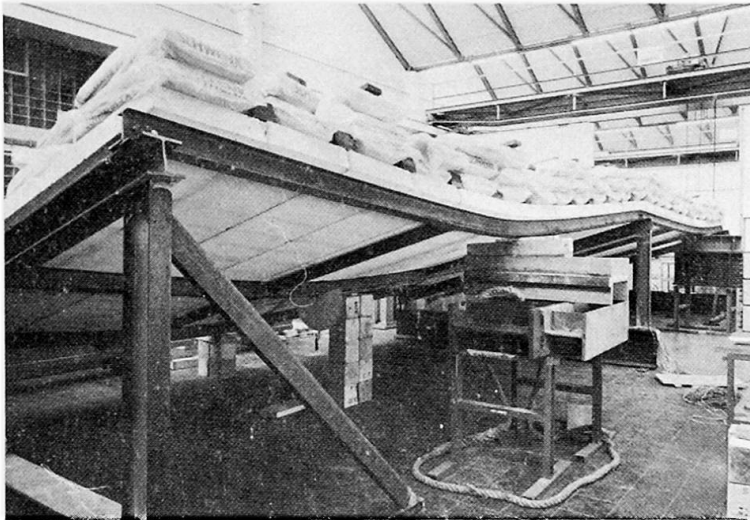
Versuch mit Gasbetonplatten; Pfette IPE 120 über 2 x 6,50 m gestützt; Druckstreben in den Drittelpunkten; Dachneigung 30 % (16,7 °)
